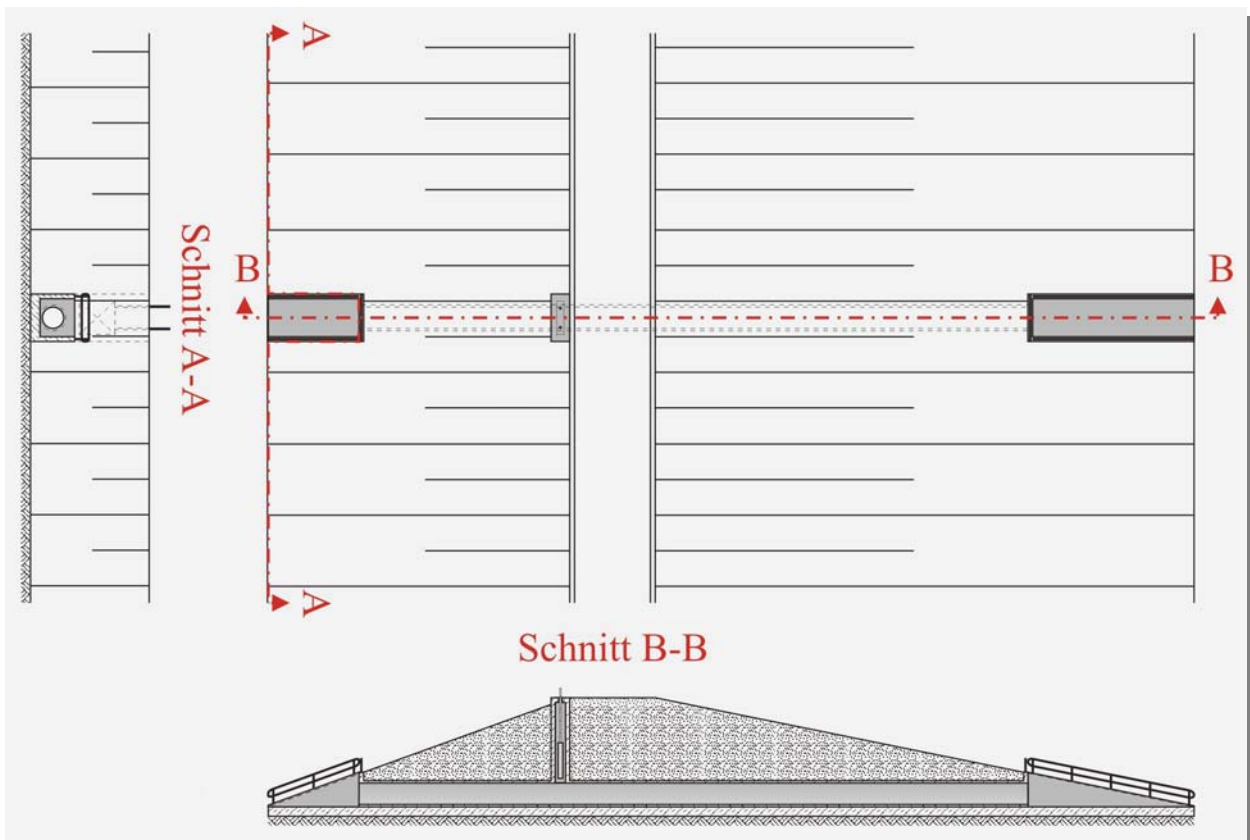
Durchlassbauwerk mit kreisrundem Rohrdurchlass und Regulierorgan
